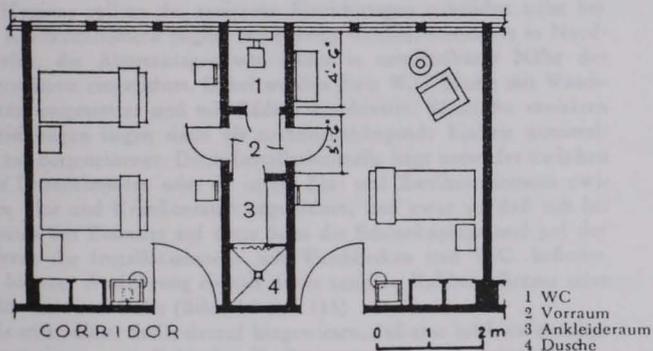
Schematischer Grundriß zweier Bettenzimmer, zwischen denen eine von beiden Zimmern erreichbare Installationszelle eingeschoben ist. Nach Rosenfield, „Hospitals“, 1. Aufl.
